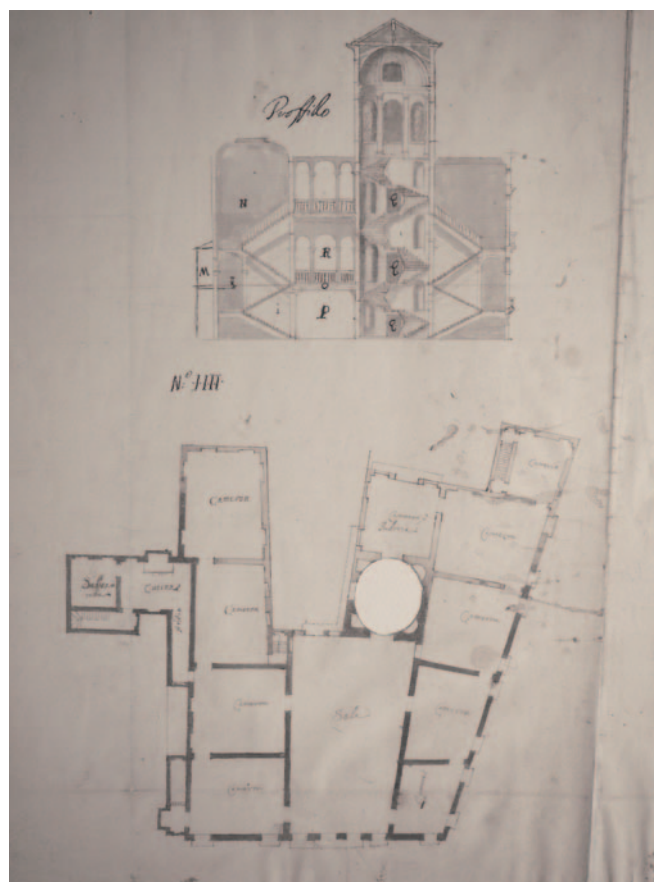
Antonio Gaspari, sezione e pianta del piano nobile di palazzo Zane (Fondazione Musei Civici di Venezia, Gabinetto dei disegni e delle stampe, *Raccolta Gaspari*, III, 8).
